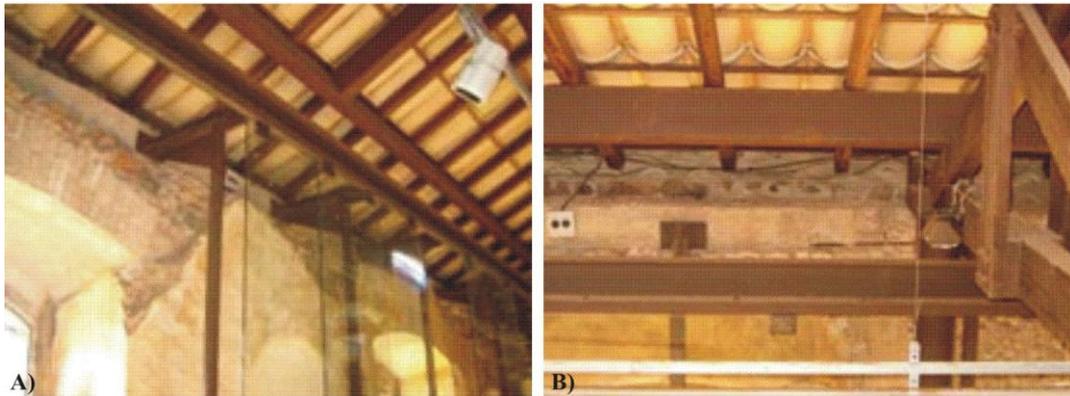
Detalhes da fixação da estrutura dos vidros na edificação existente.
